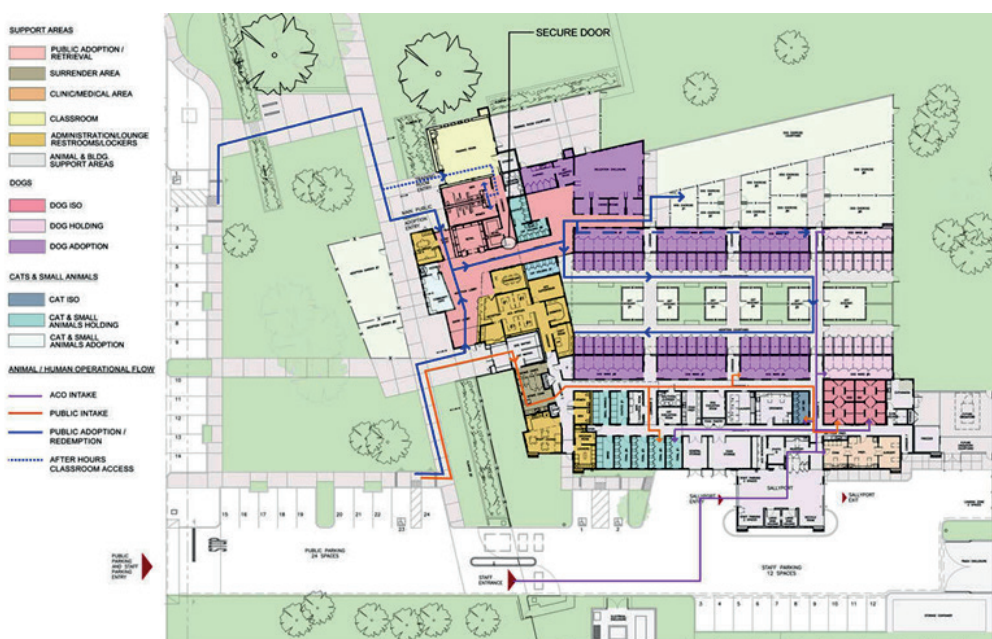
Генеральный план, совмещённый с планом 1-го этажа [2]
